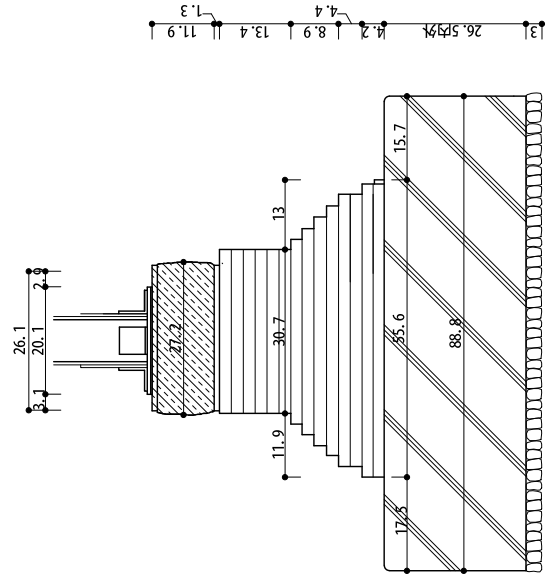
基礎位置図および平・立・断面図(実測図) 58～69頁
